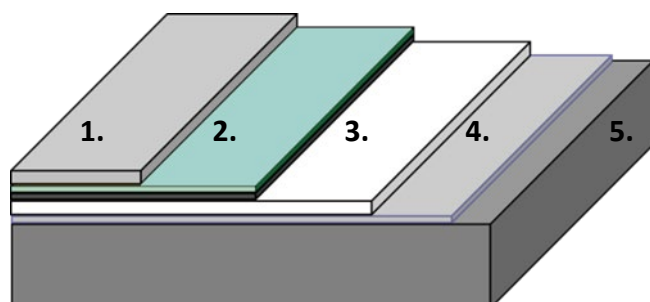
Structure du système collé sur toute la surface SikaRoof® AT
